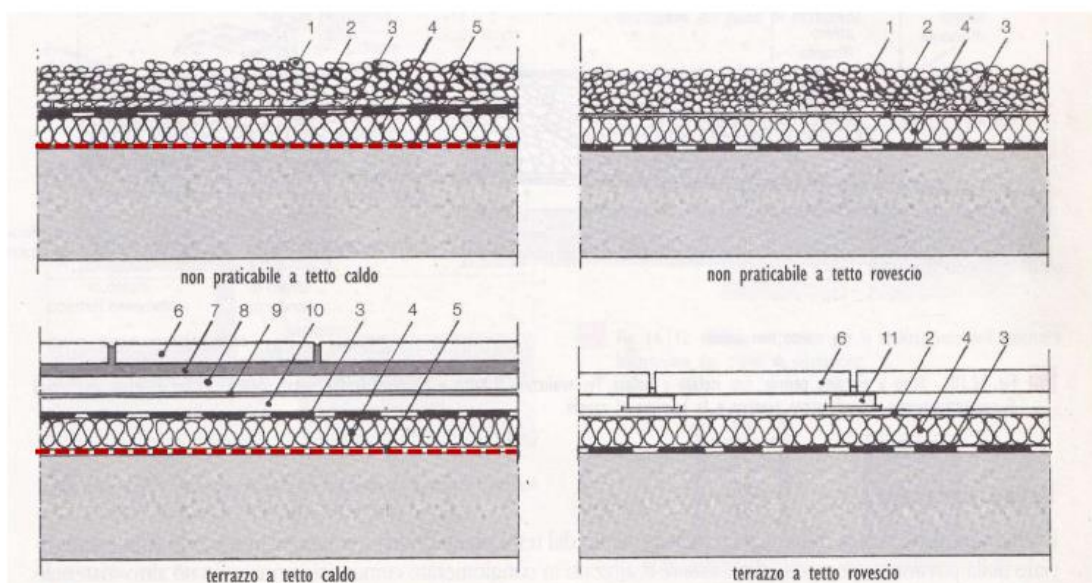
Vari tipi di tetto piano isolato. 1) Strato di ghiaietto; 2) strato di separazione; 3) strato impermeabilizzante; 4) strato di isolamento termico; 5) barriera al vapore; 6) pavimentazione in piastrelle di cemento; 7) strato di allettamento (oppure strato di incollaggio); 8) massetto di calcestruzzo; 9) strato di separazione; 10) strato di sabbia; 11) supporti angolari delle piastrelle della pavimentazione.
